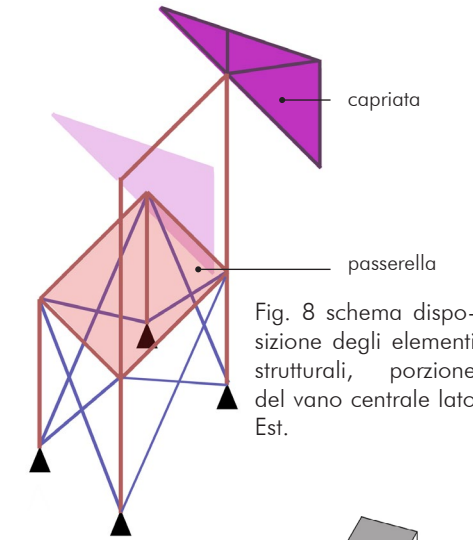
schema disposizione degli elementi strutturali, porzione del vano centrale lato Est.
